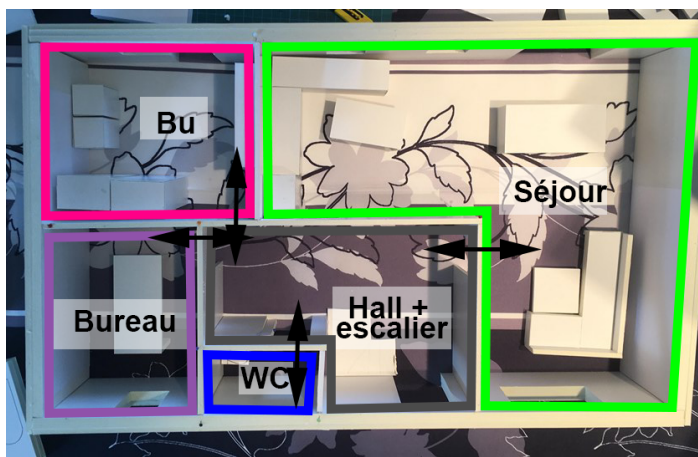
Photo du rez de chaussée après la phase 1 (Atelier V1)
